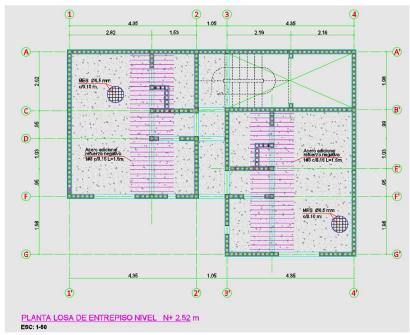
Planta losa de entrepiso – Aparta-estudios la 78
